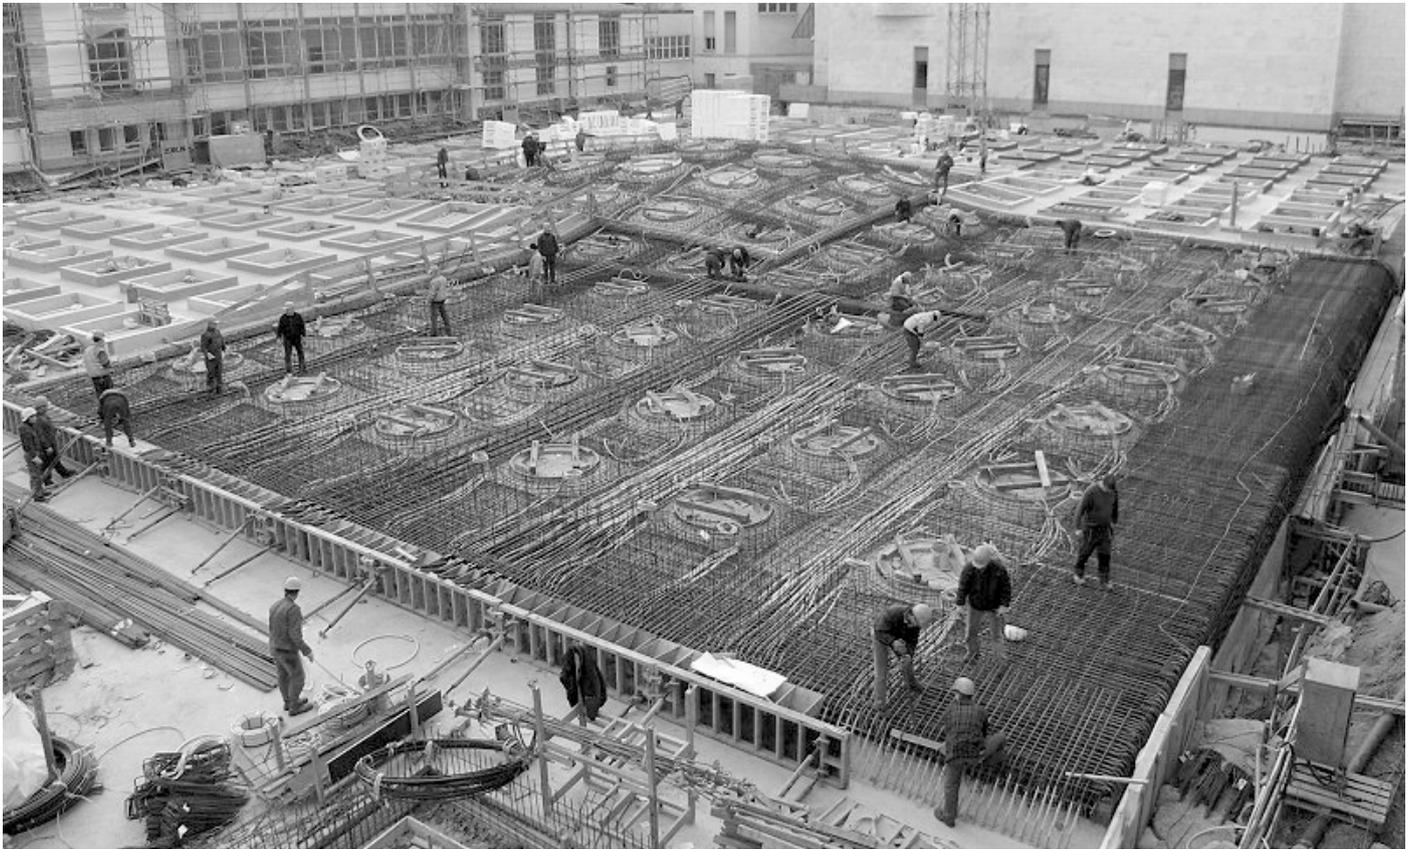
Der Beton wird zusammen mit Bewehrungsstahl vergossen
